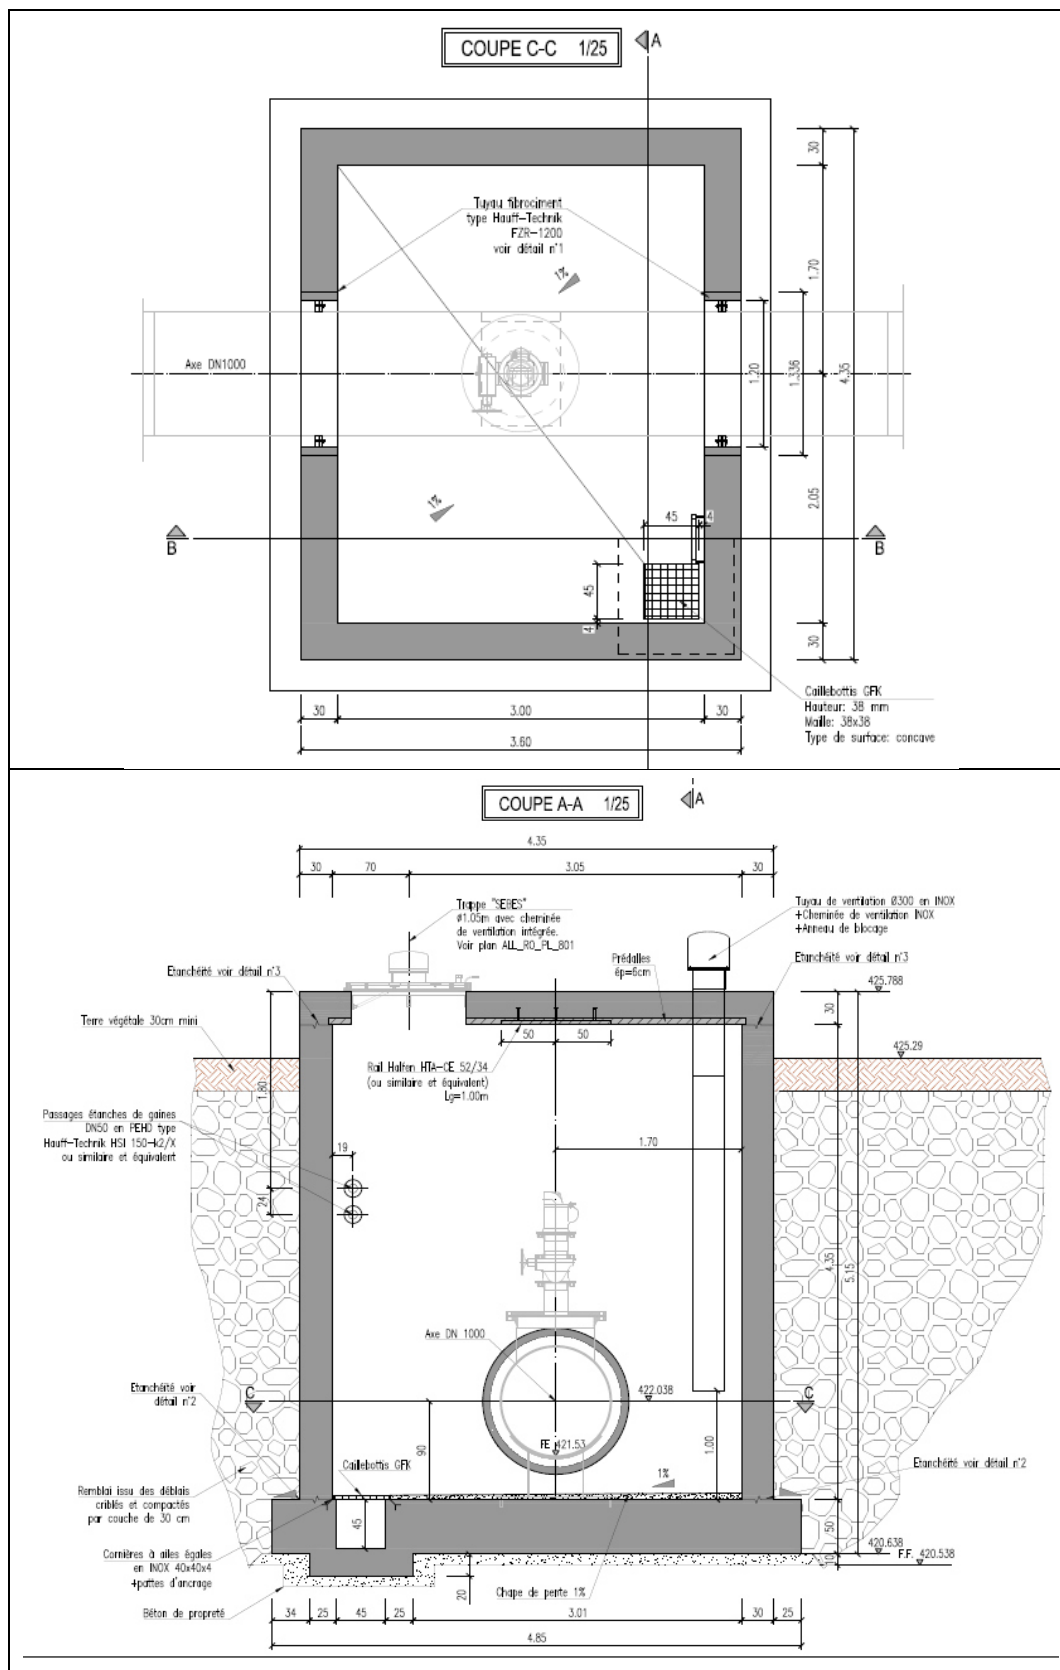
Grundriss und Querschnitt Hochpunkt (PH)
